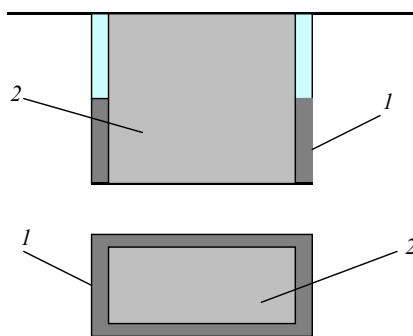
Стена в грунте: 1 – бетон; 2 – грунт
